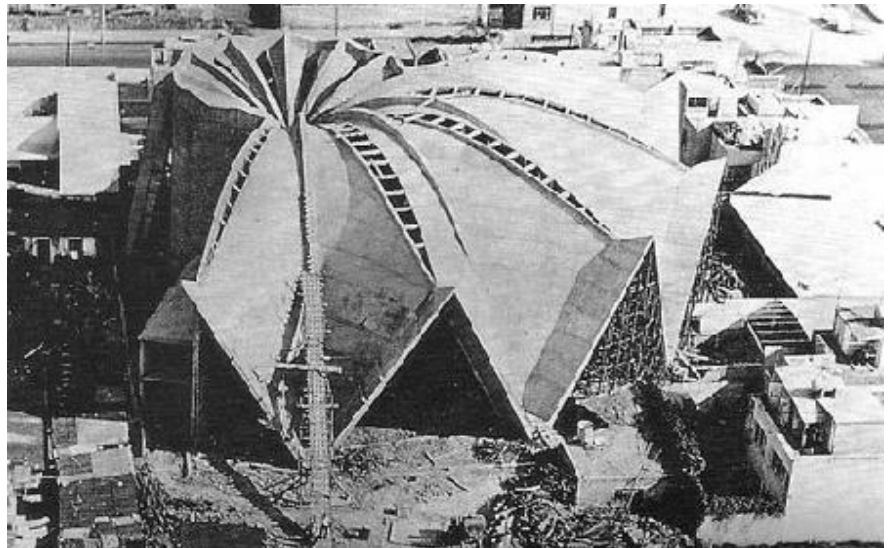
ESTRUCTURA DE LA PARROQUIA DE SANTA MÓNICA
